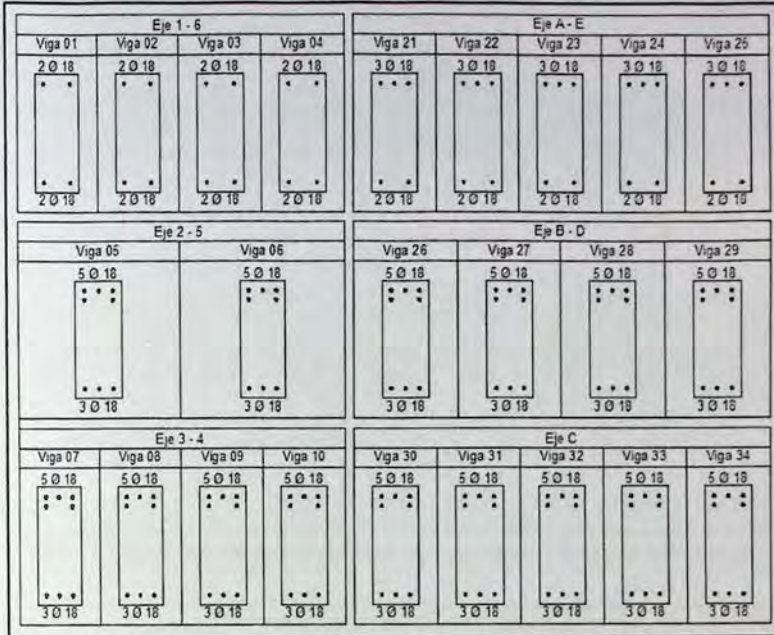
Distribución de refuerzo a flexión en vigas, ejes principales de estructura I.
